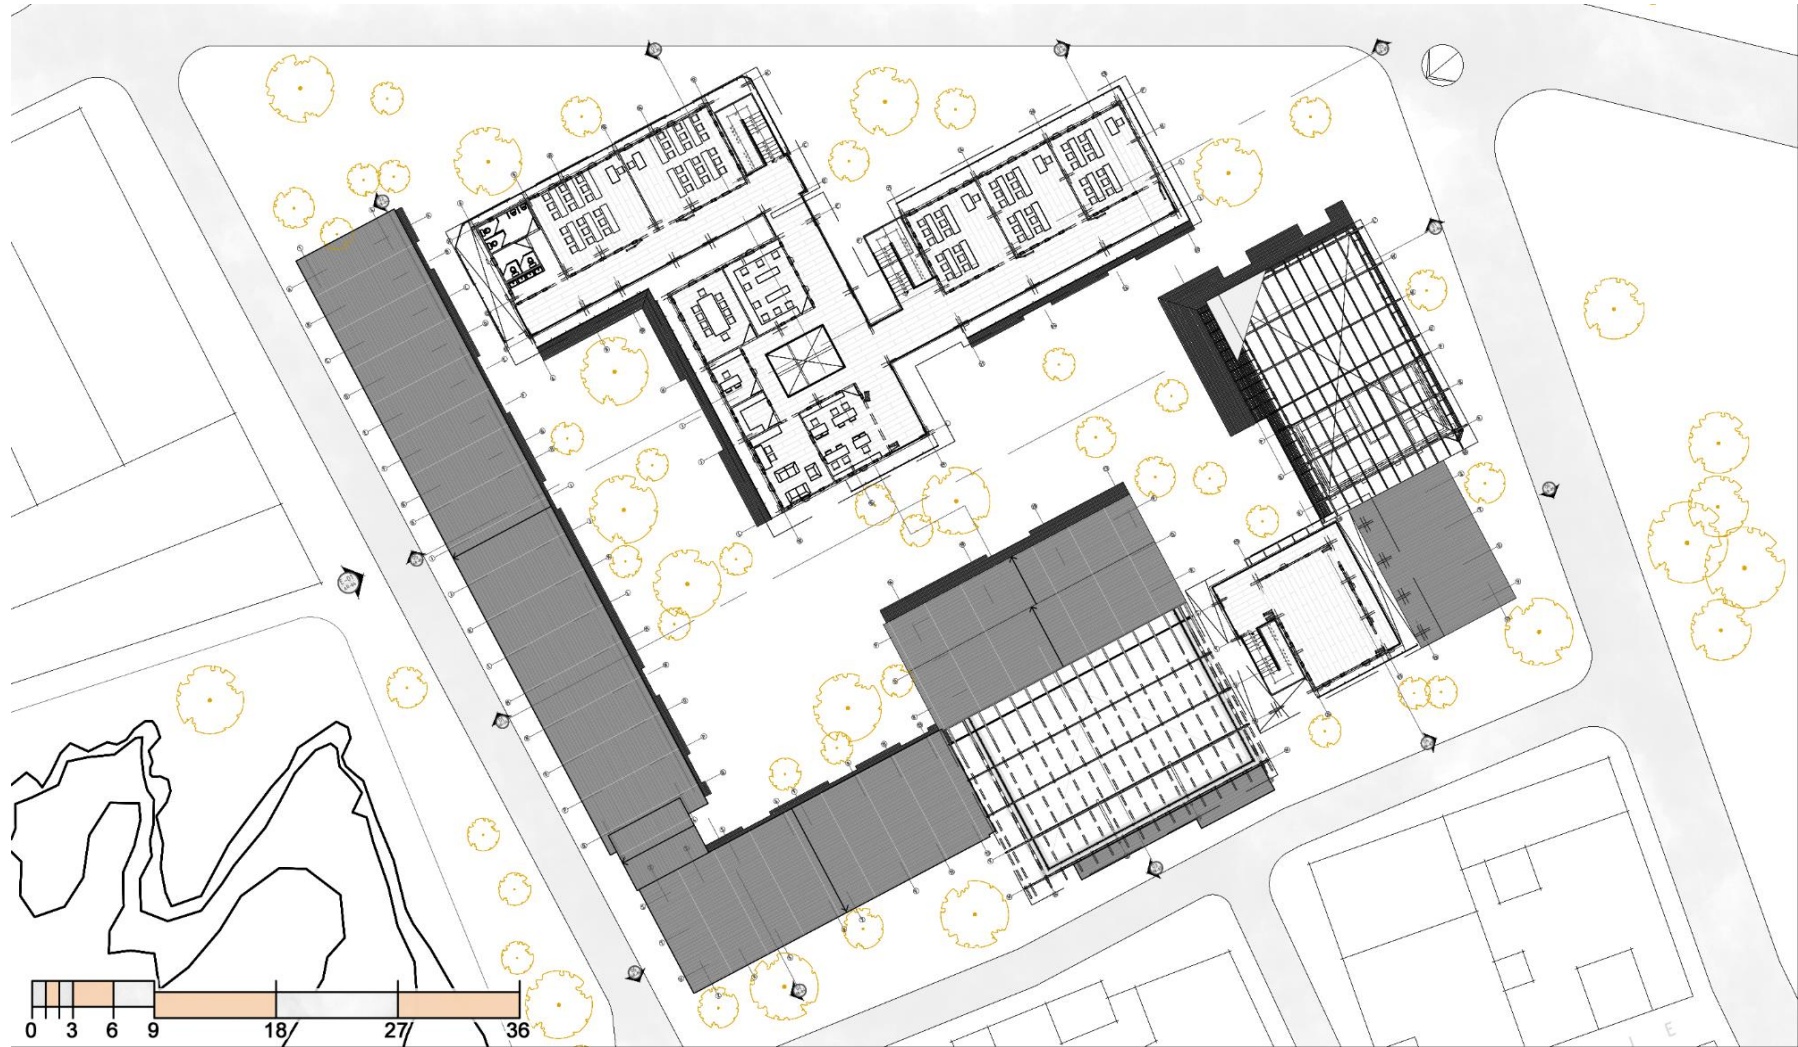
Planta Nivel Segundo. Fuente: elaboración propia.
